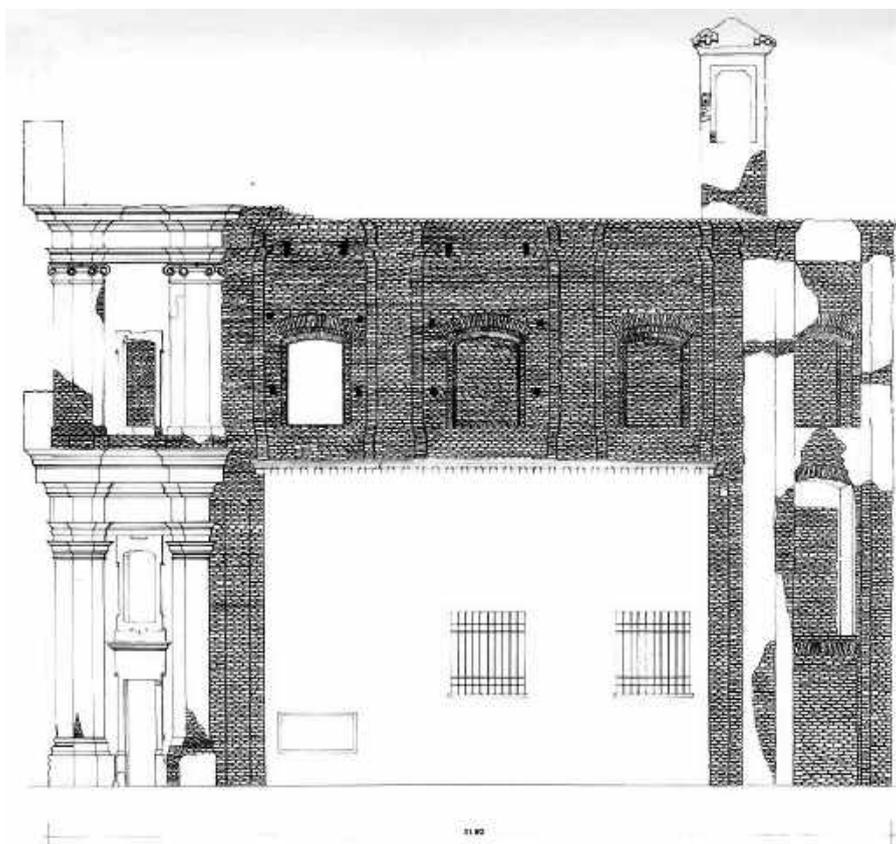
Prospetto su via San Sisto, prima dei lavori di restauro
